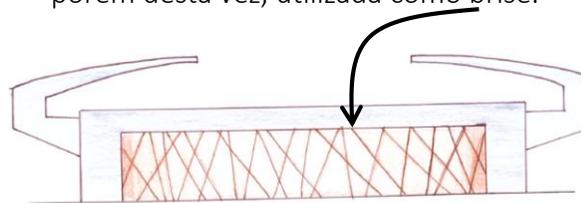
Croqui estrutura de madeira na fachada do Campo de Futebol
